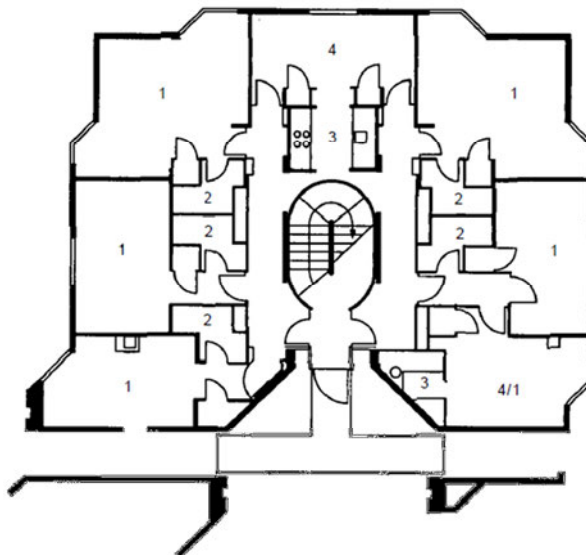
Planta do Pavimento T rreo. Balliol College, no Reino Unido.
